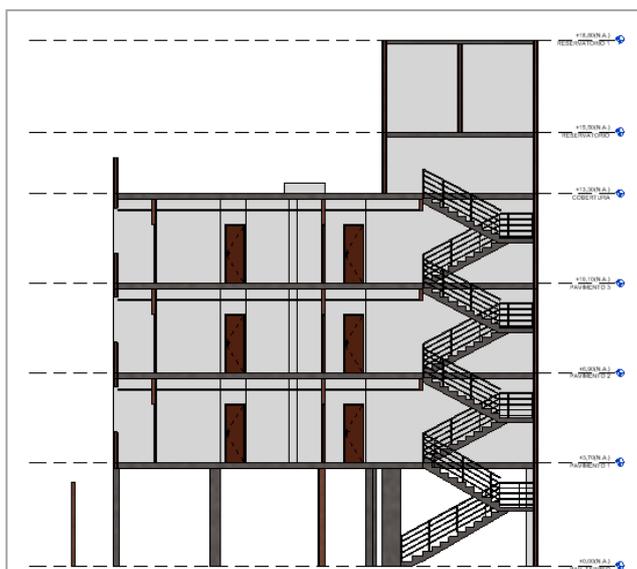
Vista em corte da edificação. (Fonte: O Autor, 2022)
